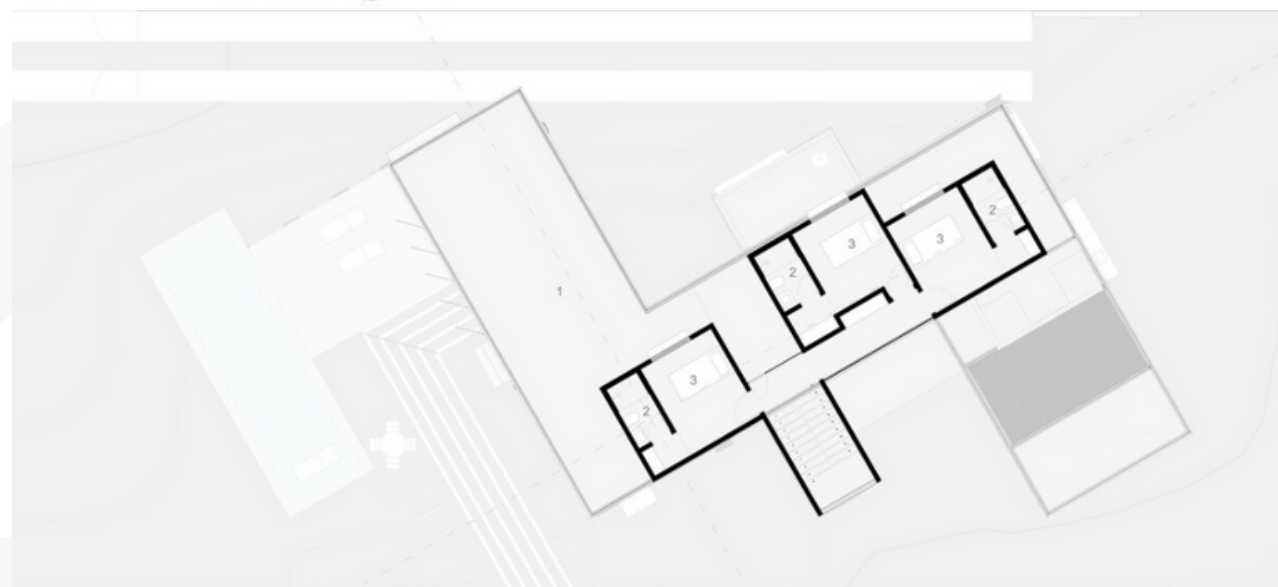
Projeto Casa Itatiba. Planta Primeiro Pavimento. Fonte: Escritório 24-7 Arquitetura.
